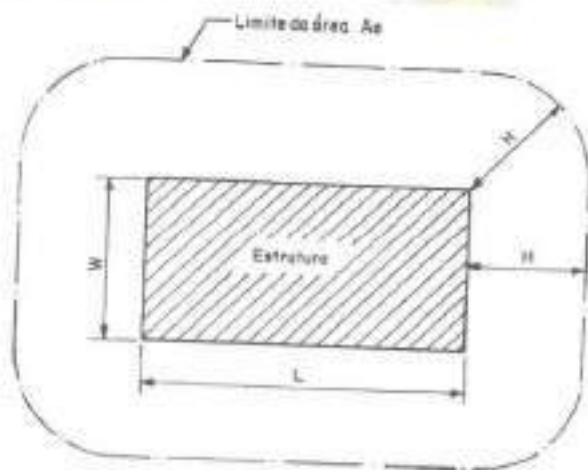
Delimitação da área de exposição equivalente ( $Ae$ ) - Estrutura vista de planta
